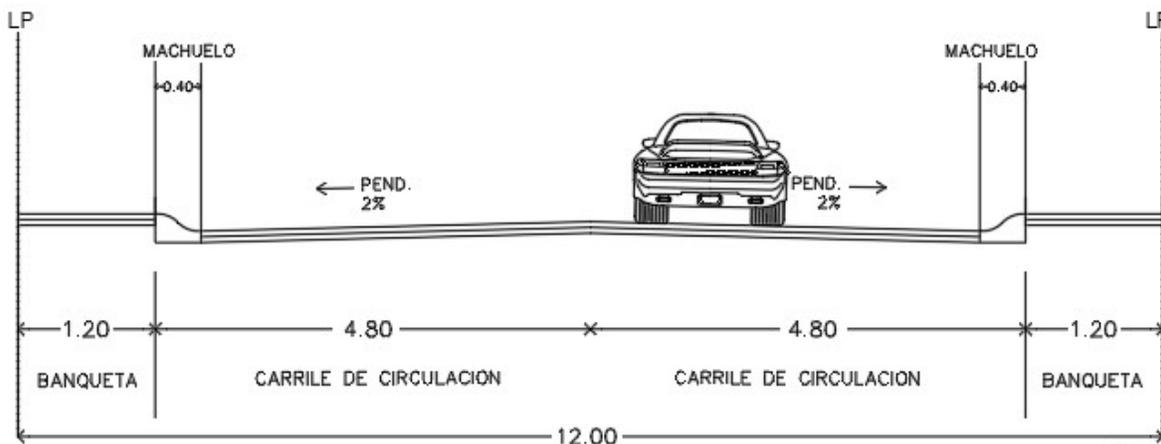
Sección vial en vialidades locales tipo privada "A"
